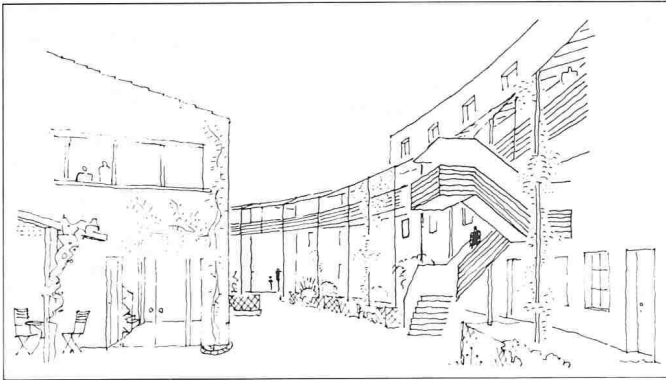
Perspektive Siedlungsinnenraum/Gestaltungsrichtplan (Standort 11 in Bild 2)
